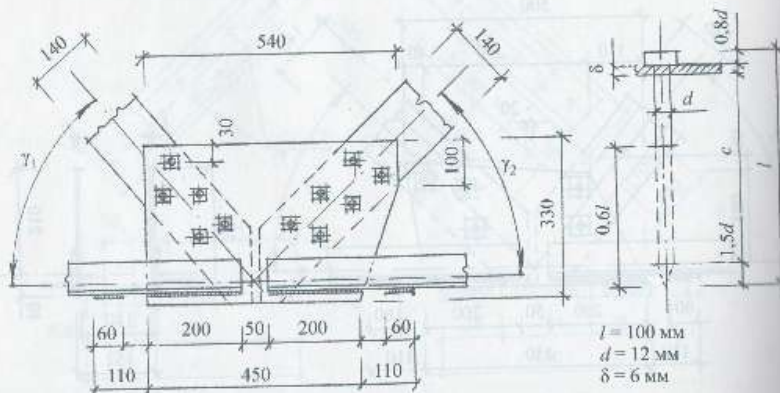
Промежуточный узел нижнего пояса фермы. Вариант 2
